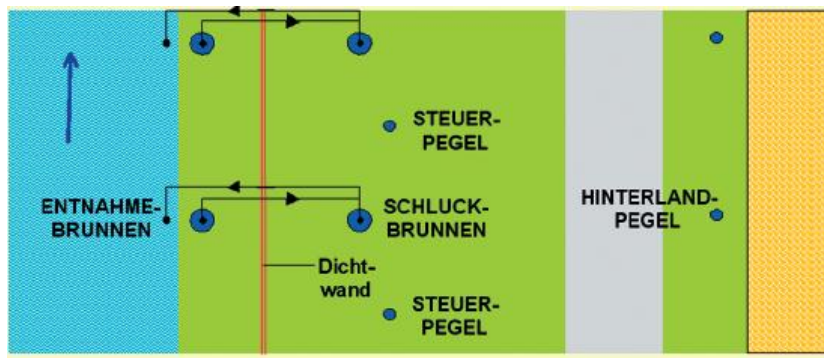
Grundwasserbewirtschaftungssystem im Grundriss (Dreher / Gunatilaka 2008: 11)
